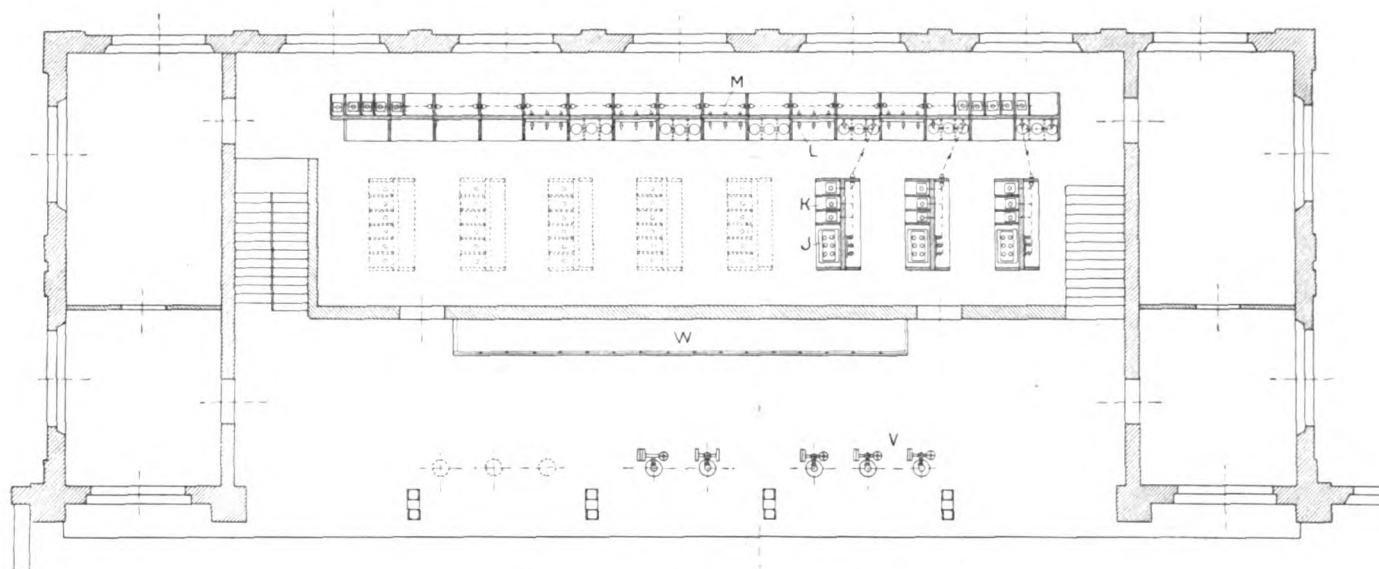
Grundriss des I. Stockwerkes.
